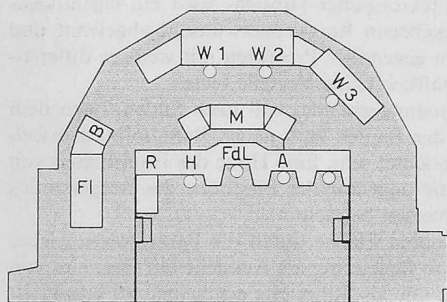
Kommandoraum, Grundriss-Schema
